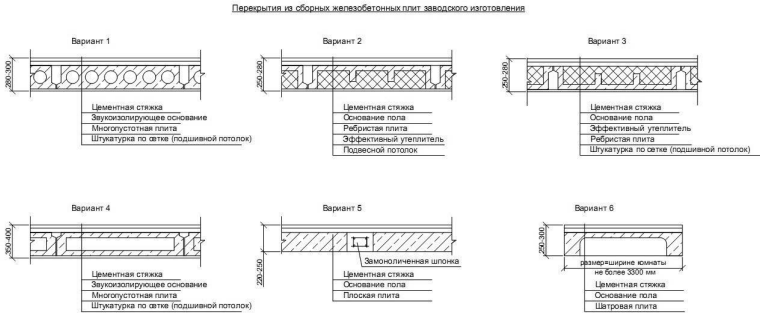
Варианты сборных перекрытий многоэтажных зданий
